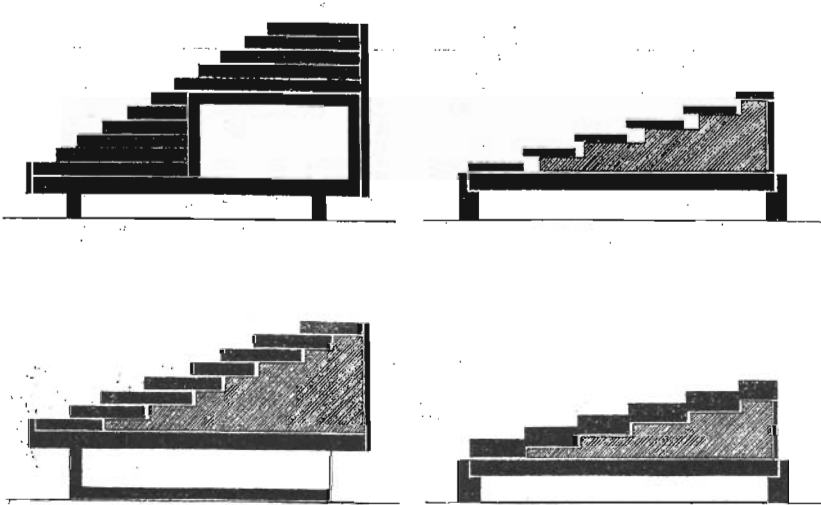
(Pág. 68 "Maquetas de arquitectura")
